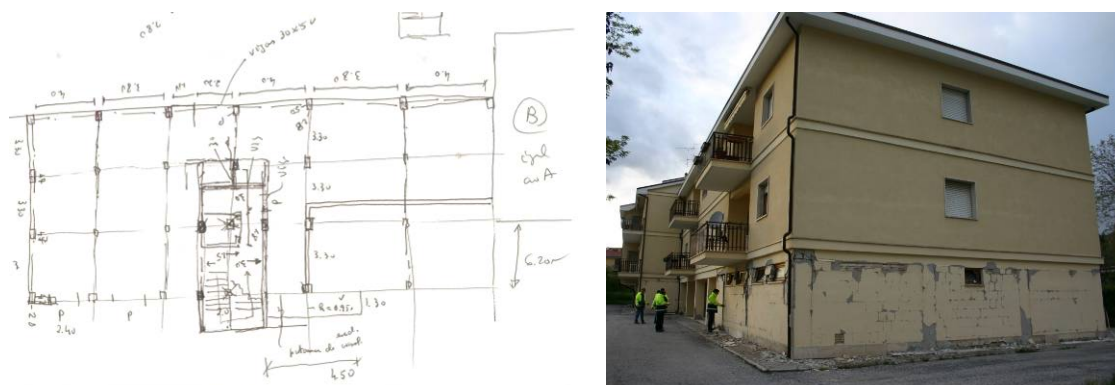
Esquema estrutural da planta estrutural e vista geral do edifício PAG04
